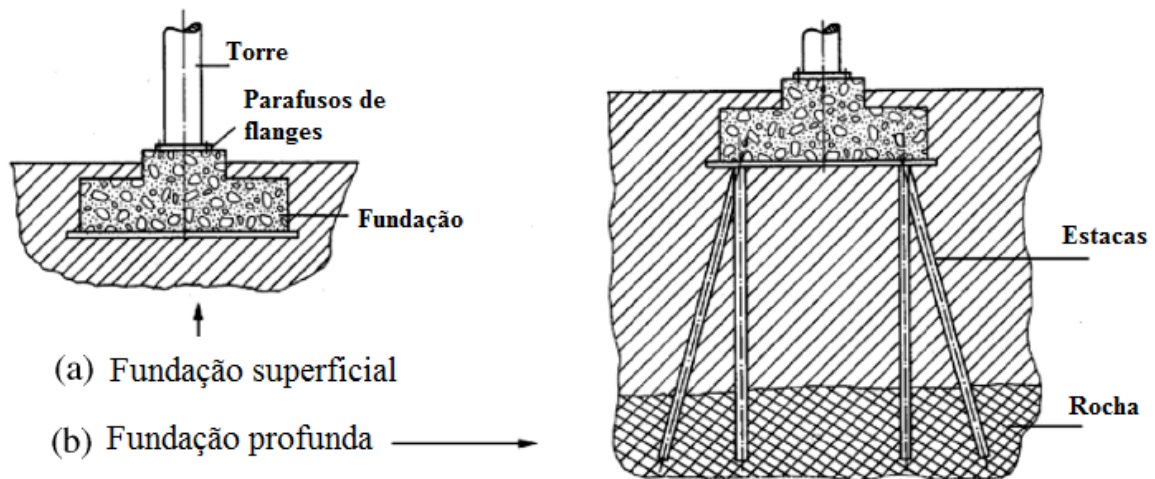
Tipos de fundações de TEHH (Fonte: adaptado de MANWELL et al., 2009)
